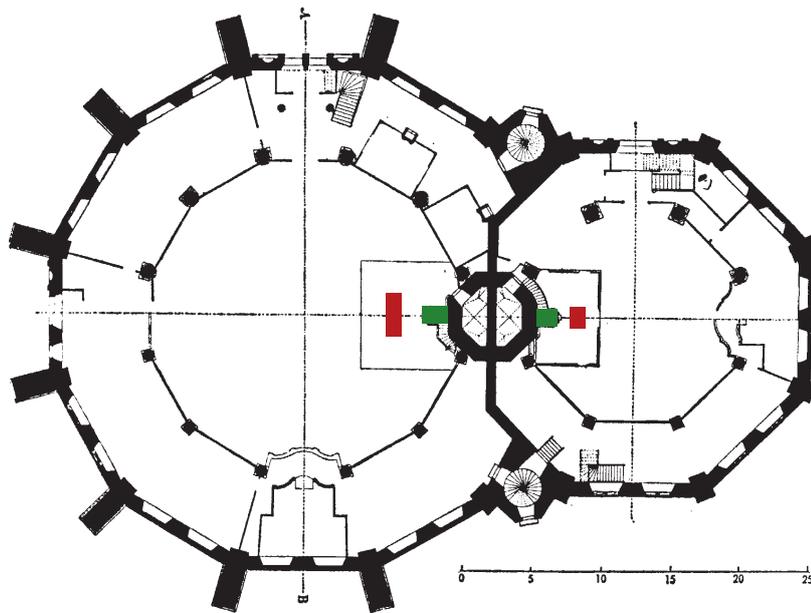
Grundriss der zwei Kirchen mit eingezeichnetem Abendmahlstisch (rot) und Kanzel (Rot)
